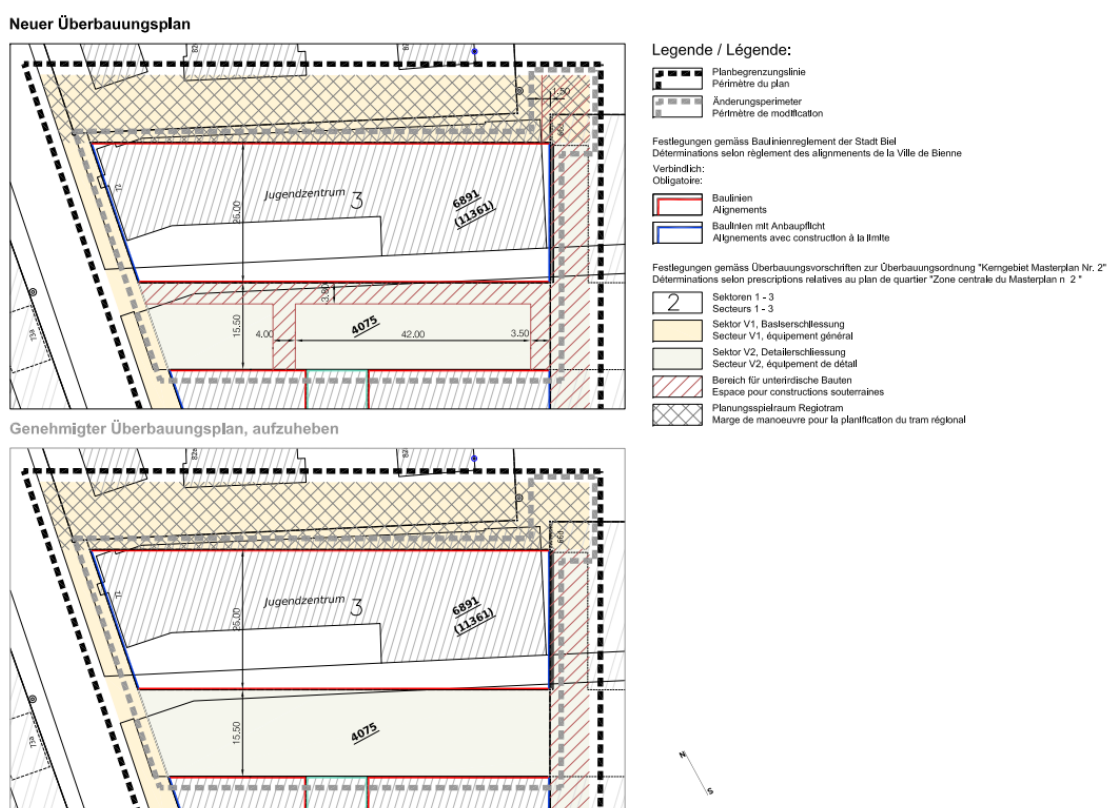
extrait du NOUVEAU plan de quartier (en haut) et approuvé/à supprimer (en bas) ; hachures : éléments de construction souterrains
